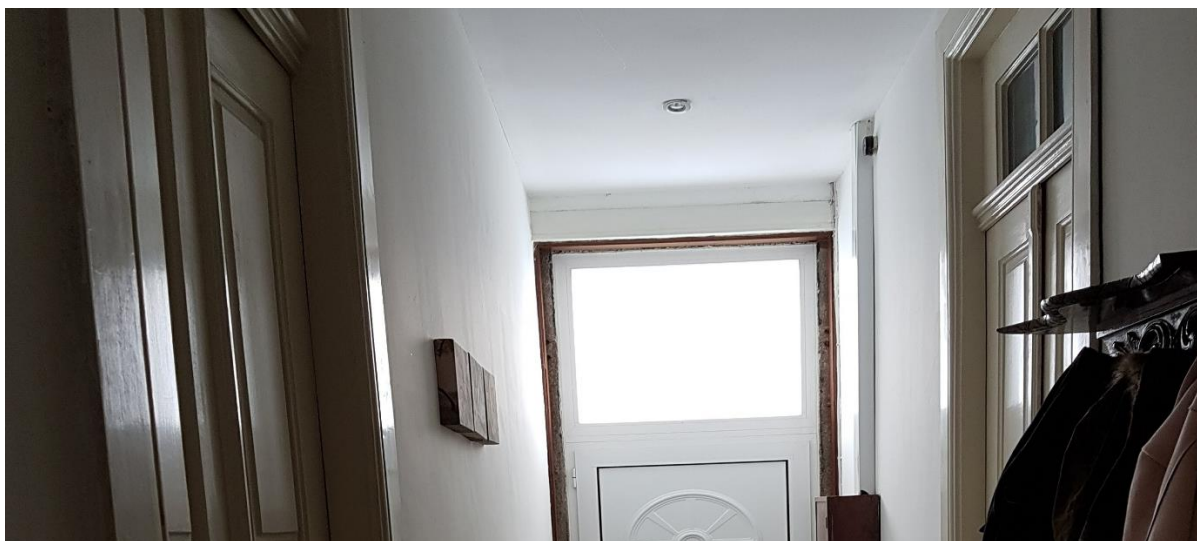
Pormenor do Teto Falso em Pladur no Hall de Entrada
